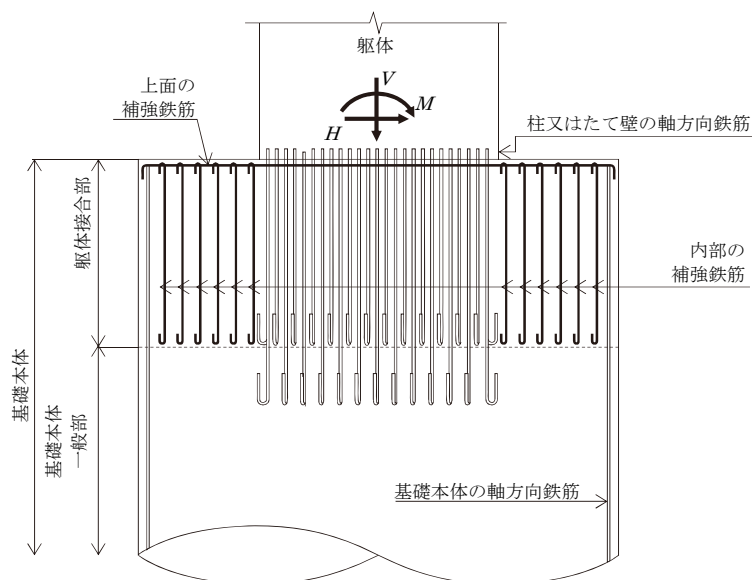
橋脚と柱状体深礎との接合部の配筋標準図
